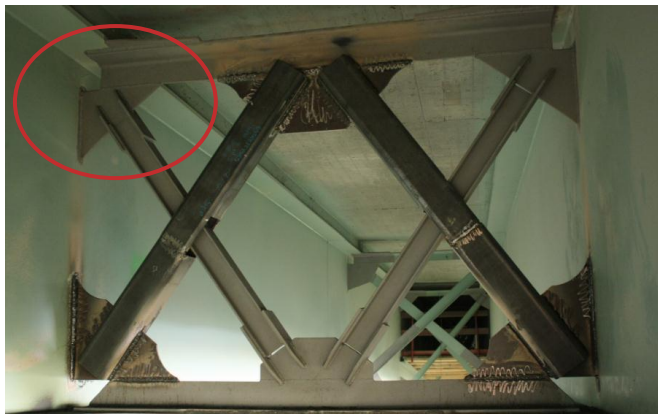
Soudure du gousset entretoise/poutre caisson
